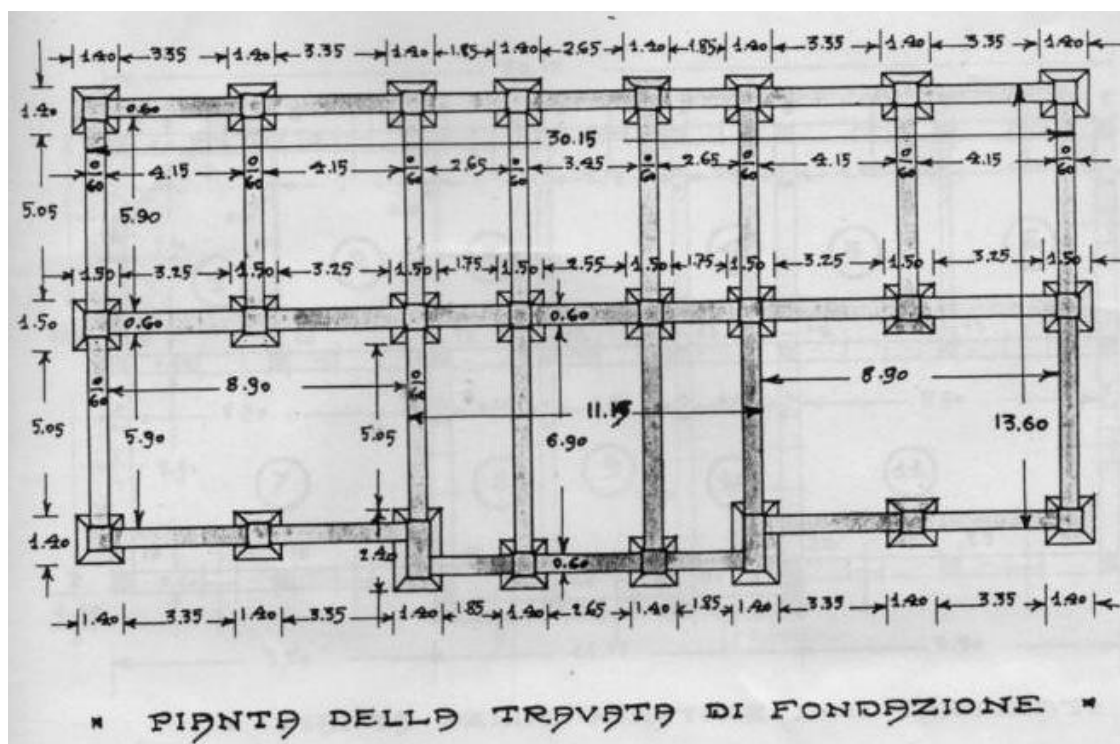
Stralcio del progetto dell'Edificio Comunale - Pianta fondazioni.
